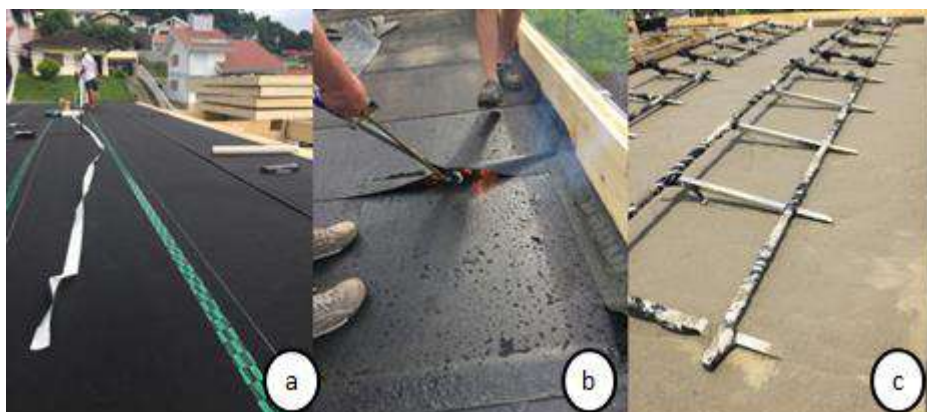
Vedação inicial (a), Colocação de manta asfáltica (b) e Suportes dos painéis fotovoltaicos na laje já concretada (c).
